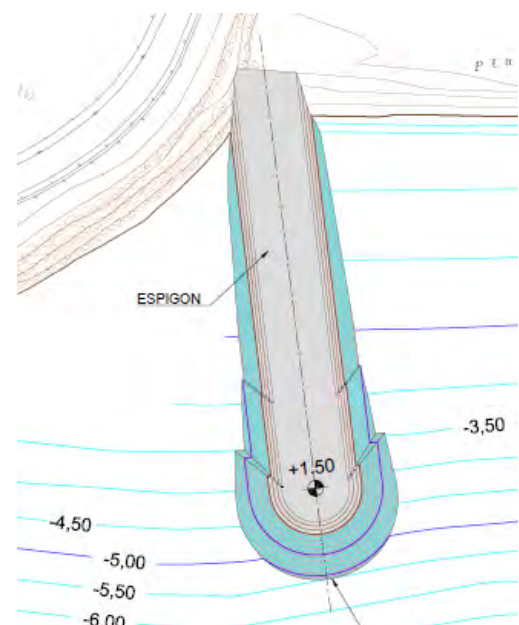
Planta de las obras (Fuente: elaboración propia)
